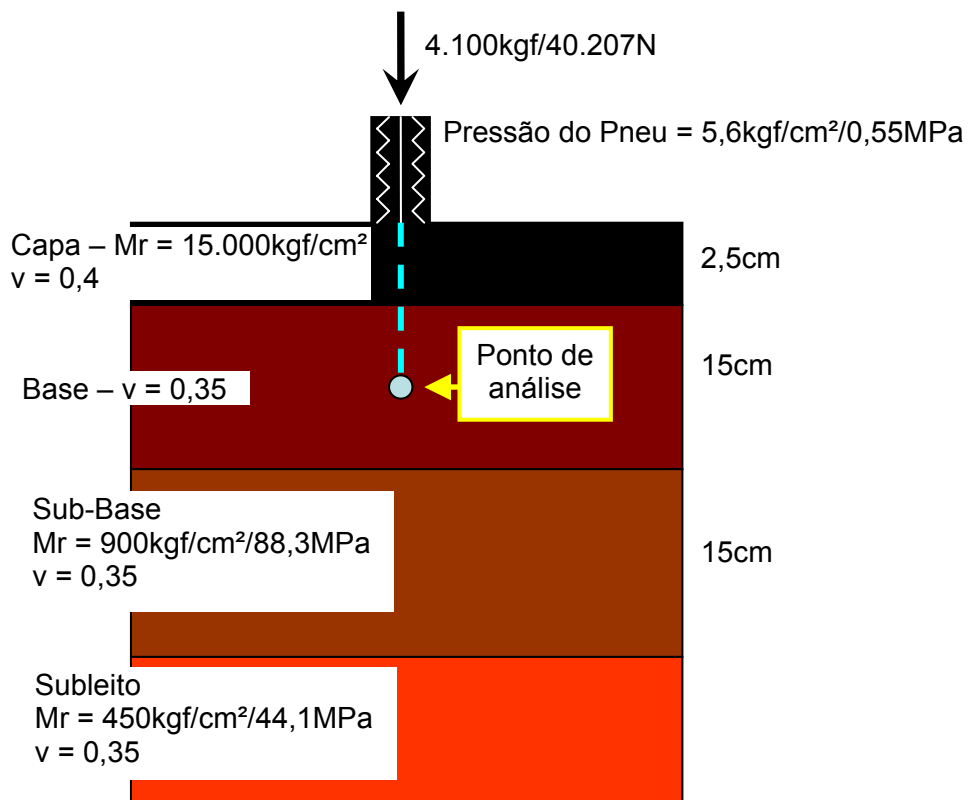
Estrutura do pavimento utilizado na simulação do módulo de resiliência.
